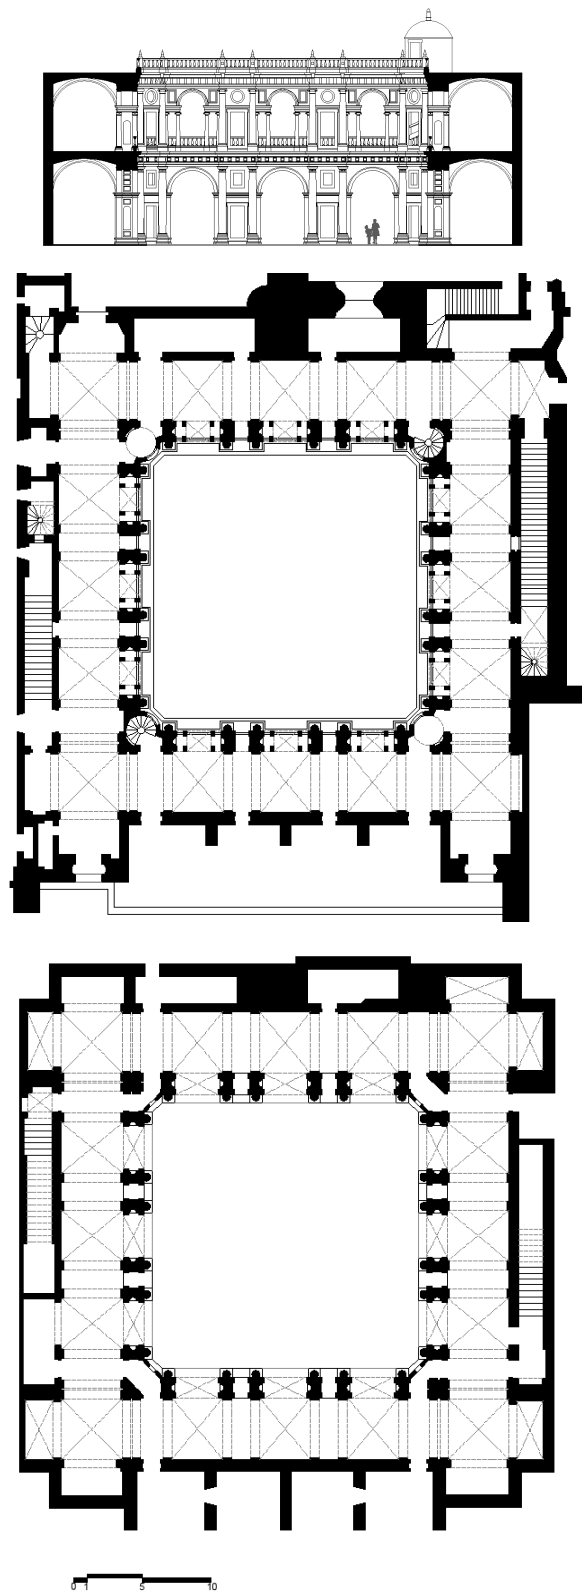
| Alçado, planta do piso superior e planta do piso térreo, do Claustro de D. João III
